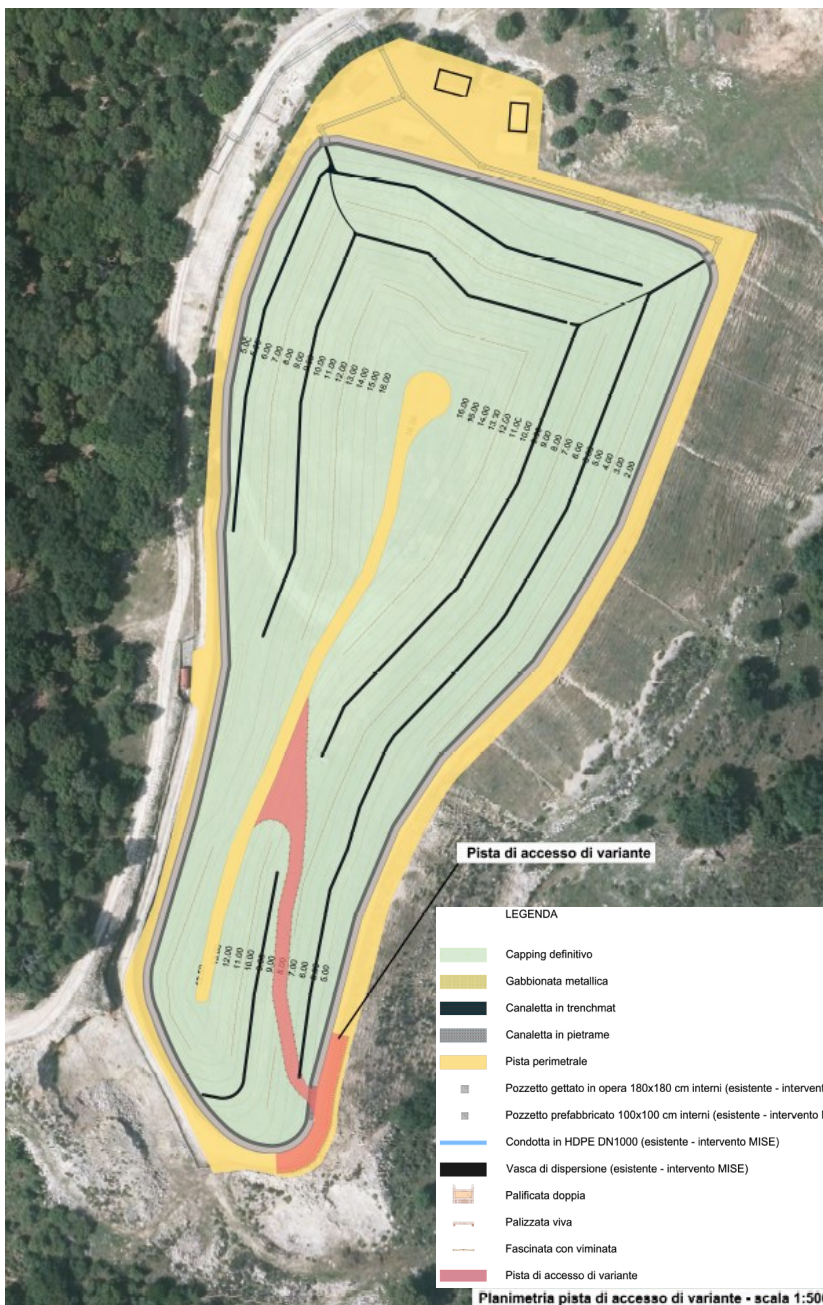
Planimetria della pista di accesso in variante, oggetto della modifica non sostanziale. (Stralcio dell'elaborato grafico "TB.0_G_Rev.0: Planimetria pista di servizio").
